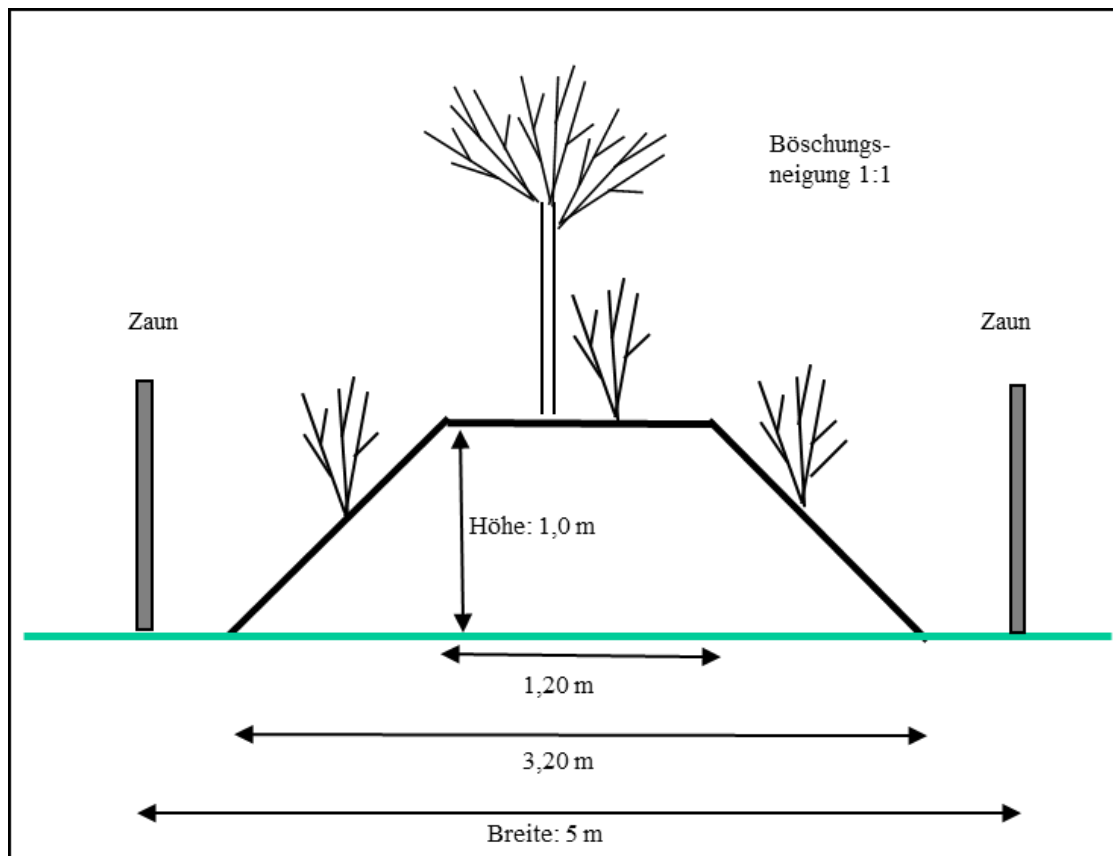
Wallprofil eines Neuen Kampwalles (Schupp & Dahl, 1992)
